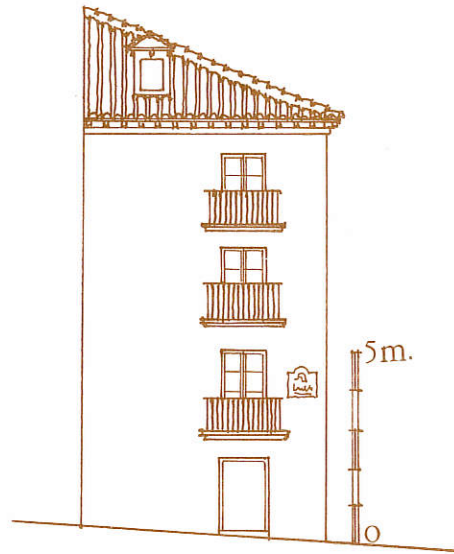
Alzado lateral L del lado nordeste de la Plaza Mayor.
